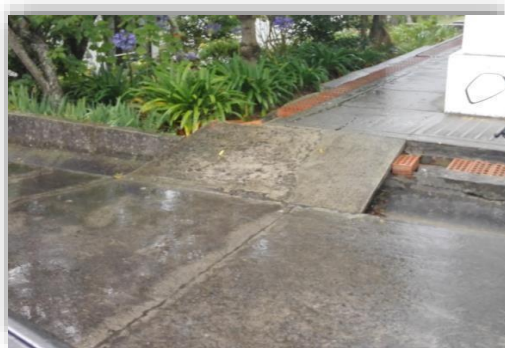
Identificación de Rampas en Planta Arquitectónica
